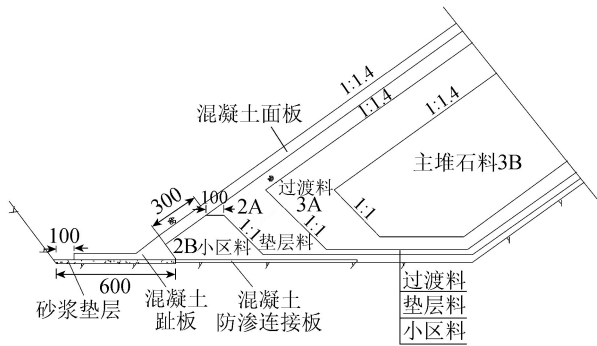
全风化基岩上混凝土趾板典型布置(单位:cm)
